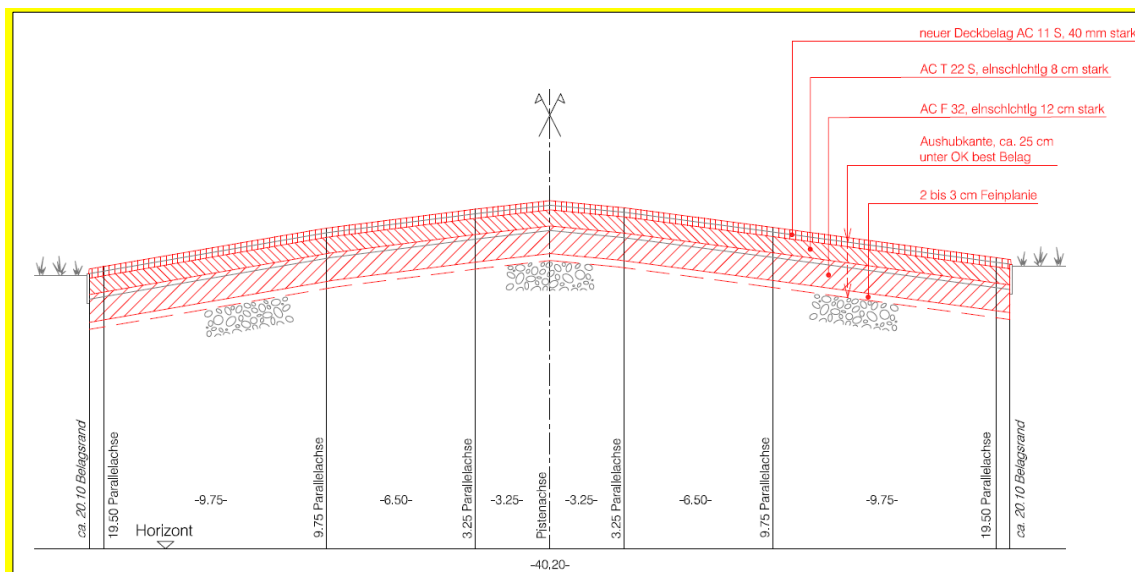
Normalprofil Pistensanierung Meiringen, Variante Tiefeinbau
